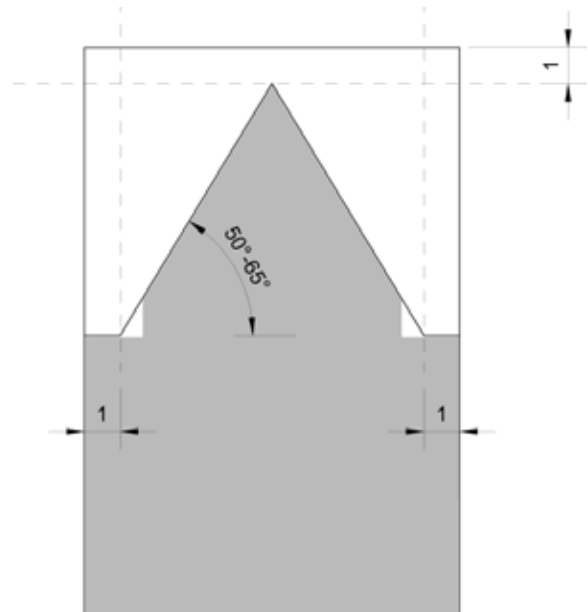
maximale Hüllfläche für Dacherker (mit beispielhaftem Dacherker/Fassadenfläche (grau))
